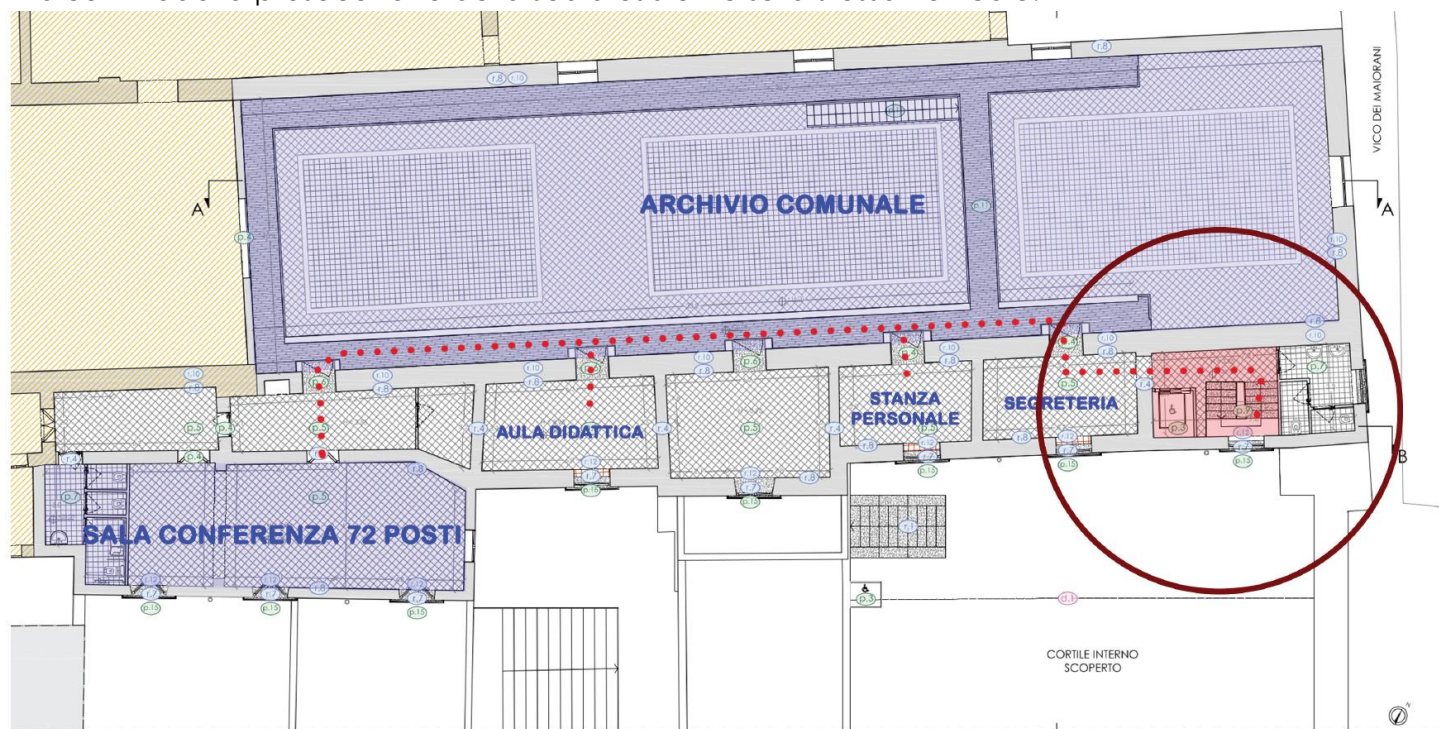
Progetto definitivo - pianta a q. 19.56 m
